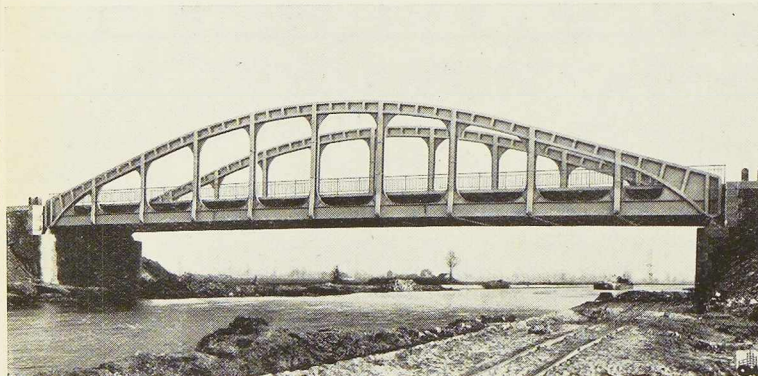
Pont de Bocholt, entièrement soudé, de 55 mètres, construit en 1934.
